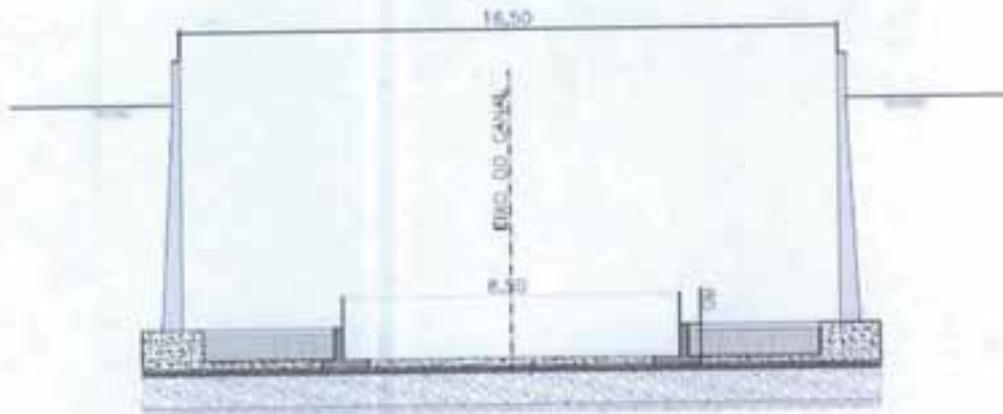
Detalhe da Seção do Canal em Execução da Canalização do Córrego Ponte Baixa.
